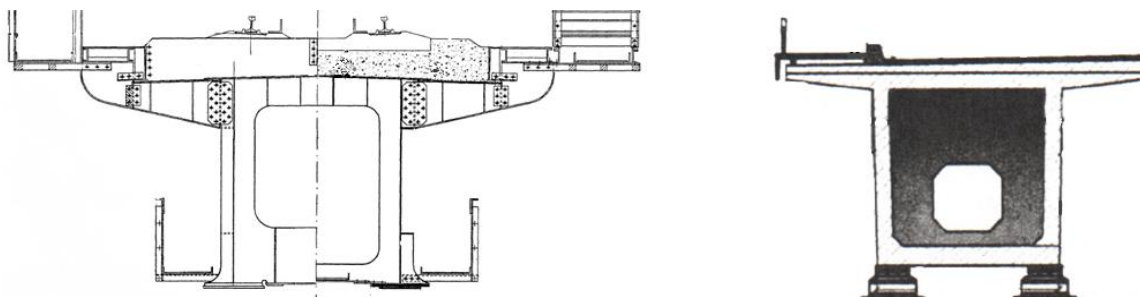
Типовые решения мостовых балочных конструкций из стали и железобетона
